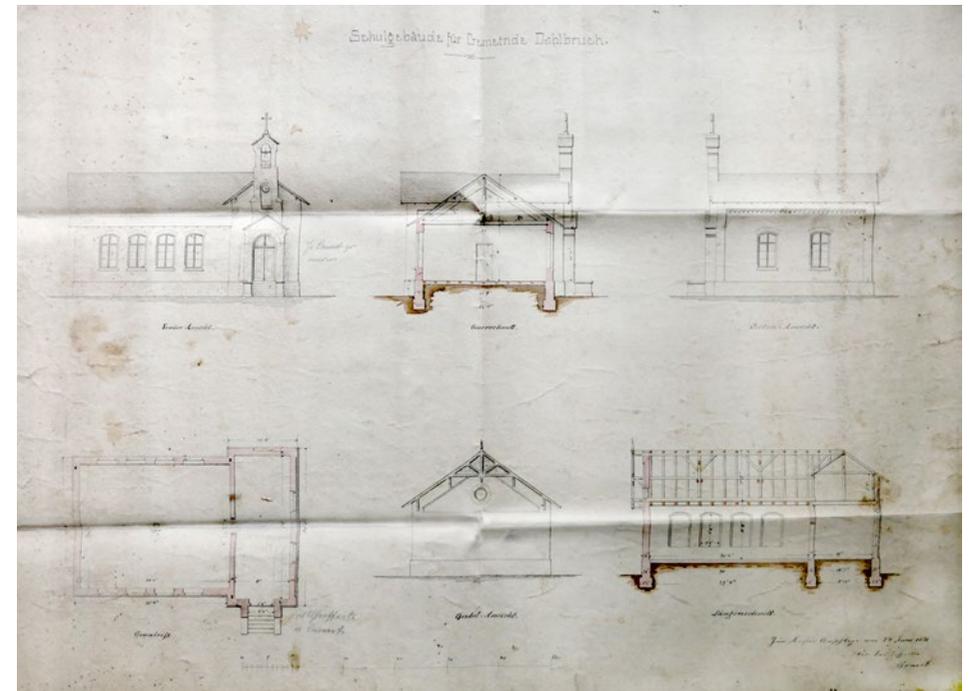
Schulhaus mit einem Klassenraum, Plan, Wilhelm Benoit, 27.6.1871
